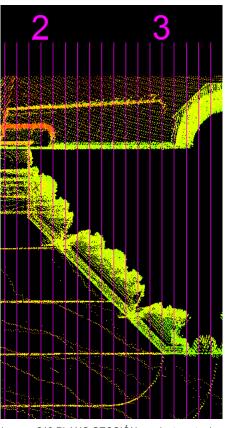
PLANO SECCIÓN en planta entre las divisiones 2 y 3 y las subdivisiones de 100 mm. . Fuente propia.
